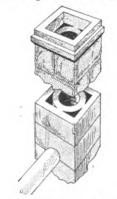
Ramin aus Beton-Wertfteinen mit Edenlüftung.
